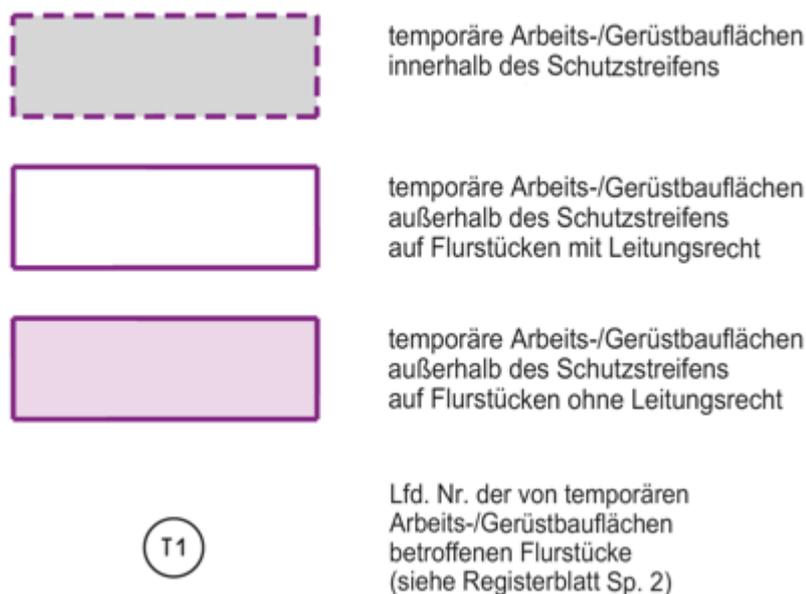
Darstellung Arbeits-/Gerüstbauflächen
